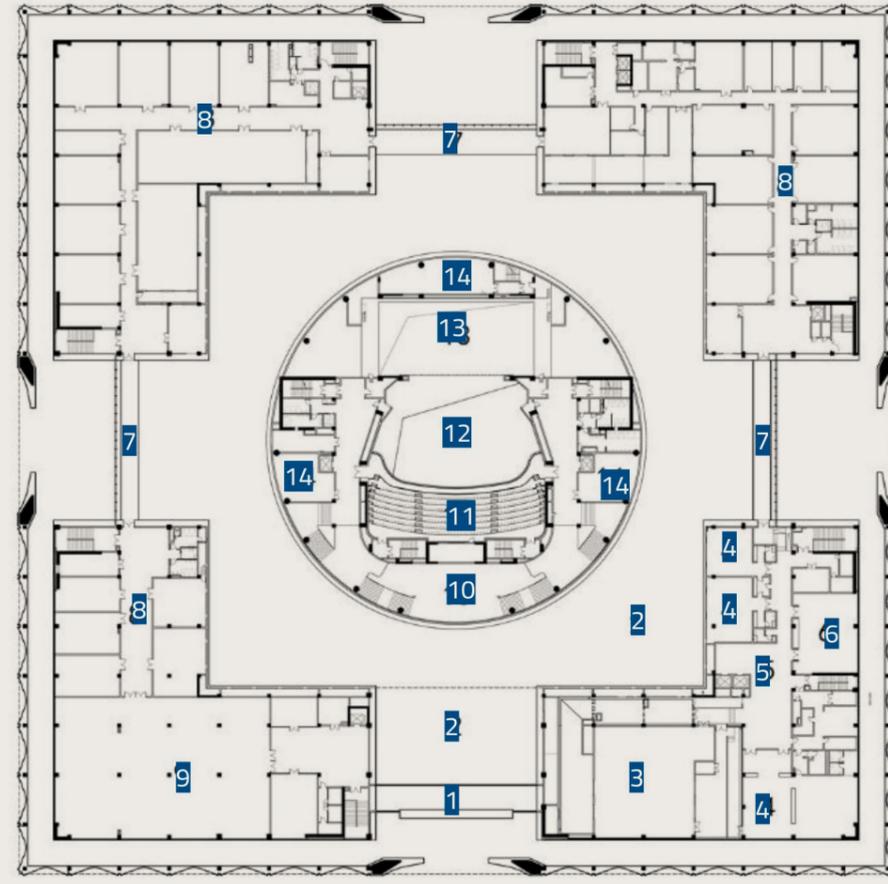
Planta do Segundo Pavimento. 0 5 10 20m
